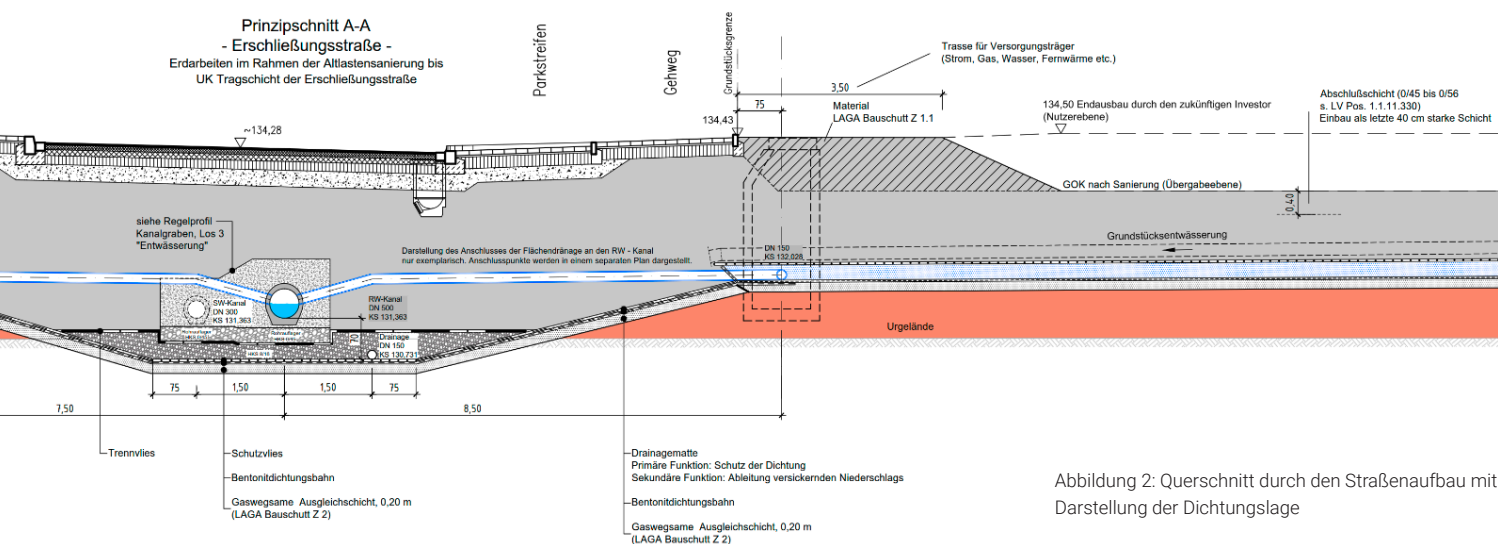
Querschnitt durch den Straßenaufbau mit Darstellung der Dichtungslage
